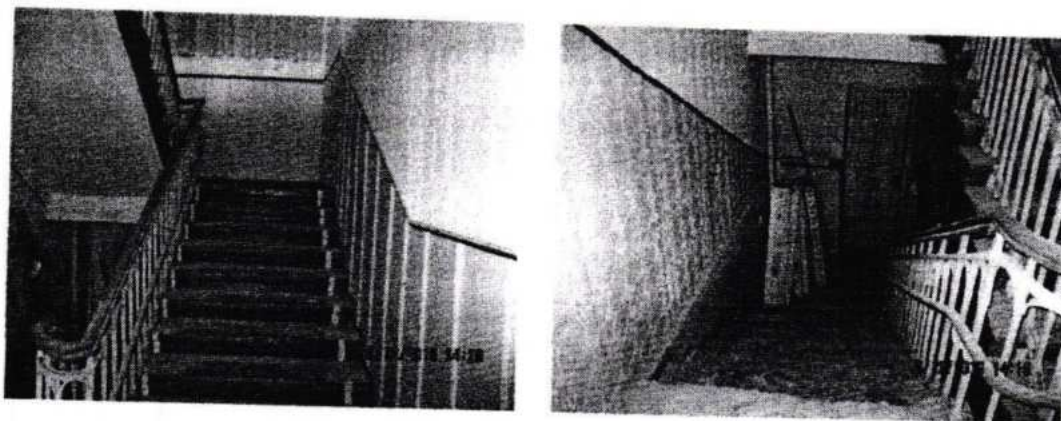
Aspectul elementelor structurii de rezistență ale scării în componența rampelor și podestelor scării.
